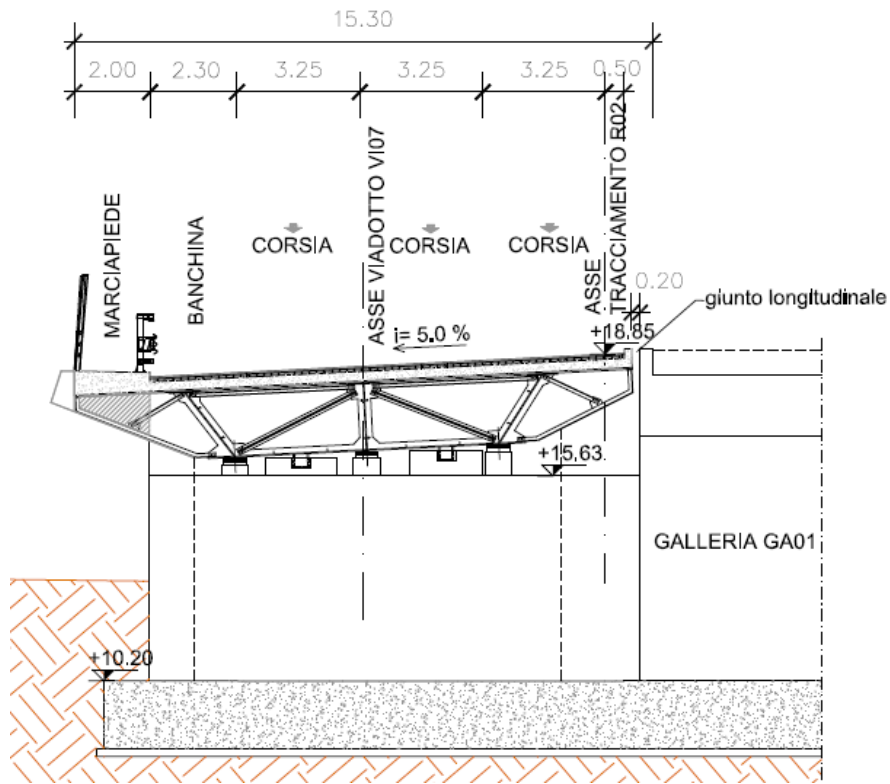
Viadotto VI07 - Sezione trasversale su pila
